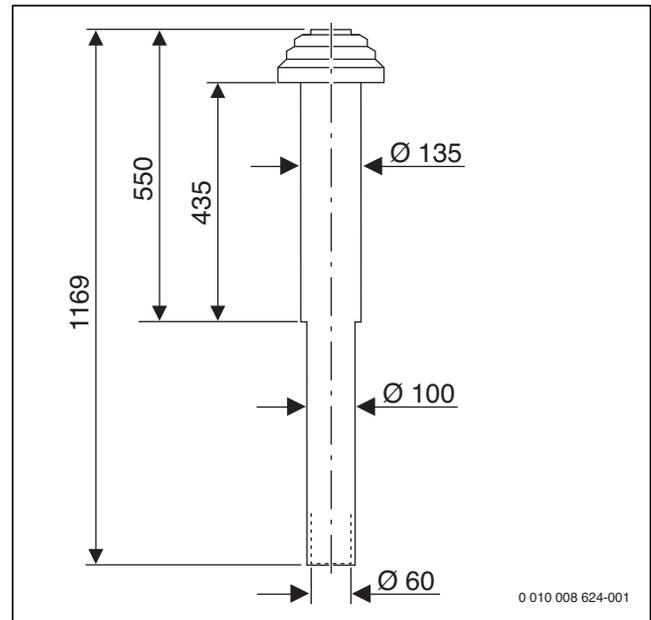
Dachdurchführung Ø 60/100 (Maße in mm)
